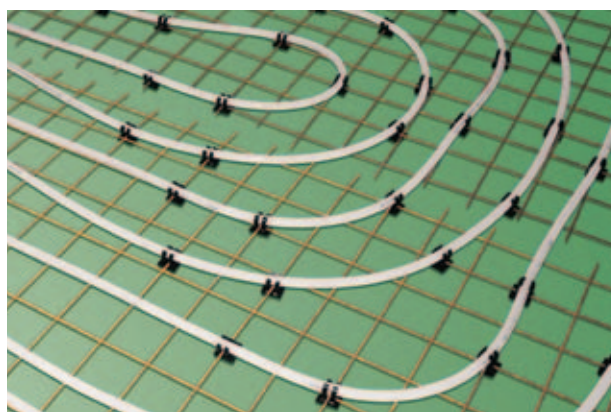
Isolamento termico con riscaldamento a pavimento.
